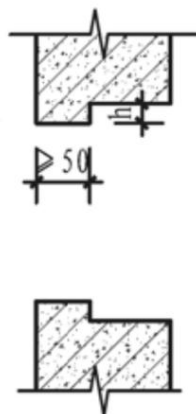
混凝土外墙门窗洞的企口设置示意图
